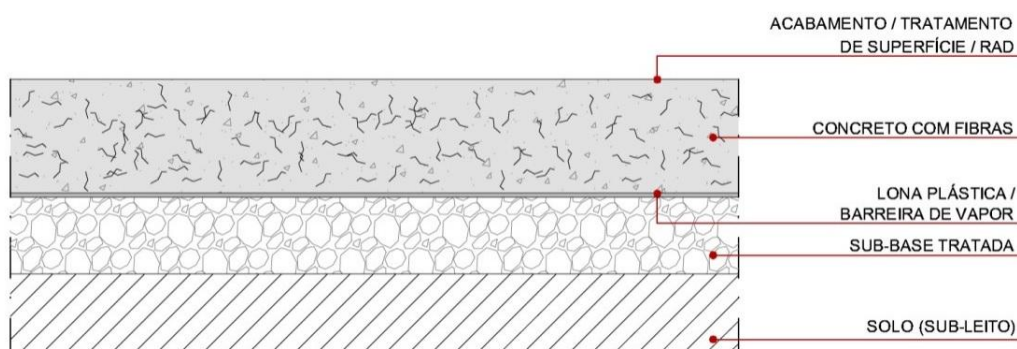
Piso de concreto com fibras (Fonte: CRISTELLI, 2010)
